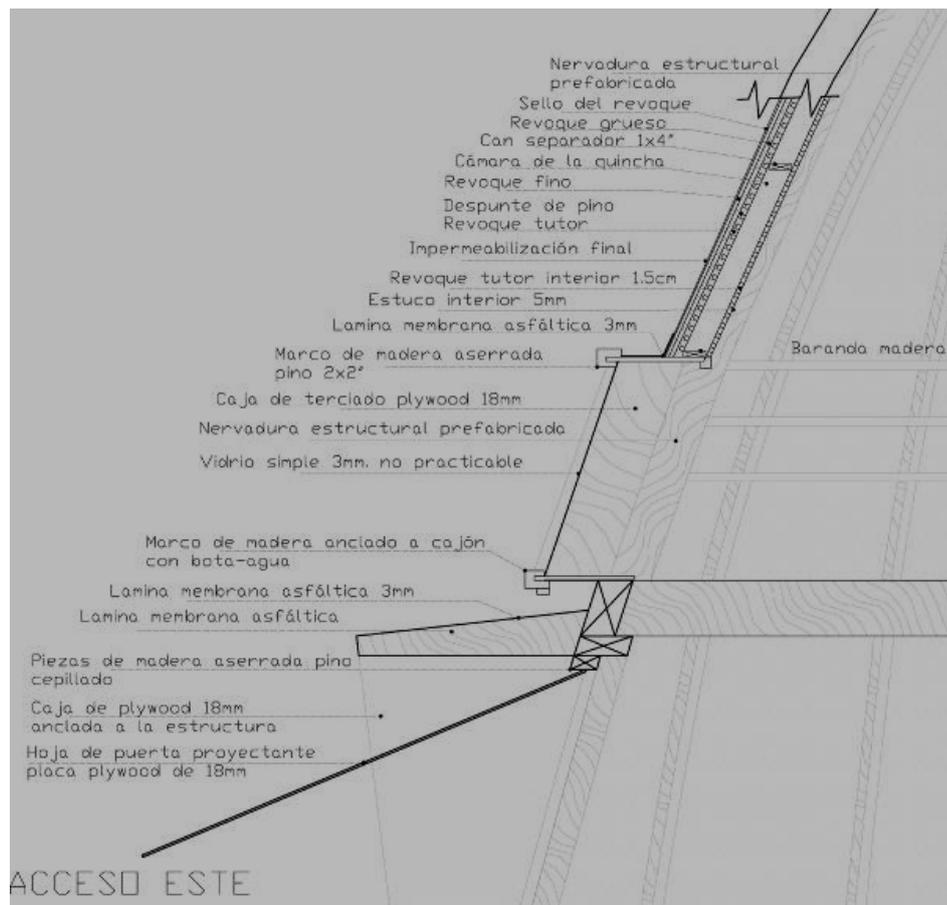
Sección del perfil /escantillón, pasando por el acceso este
